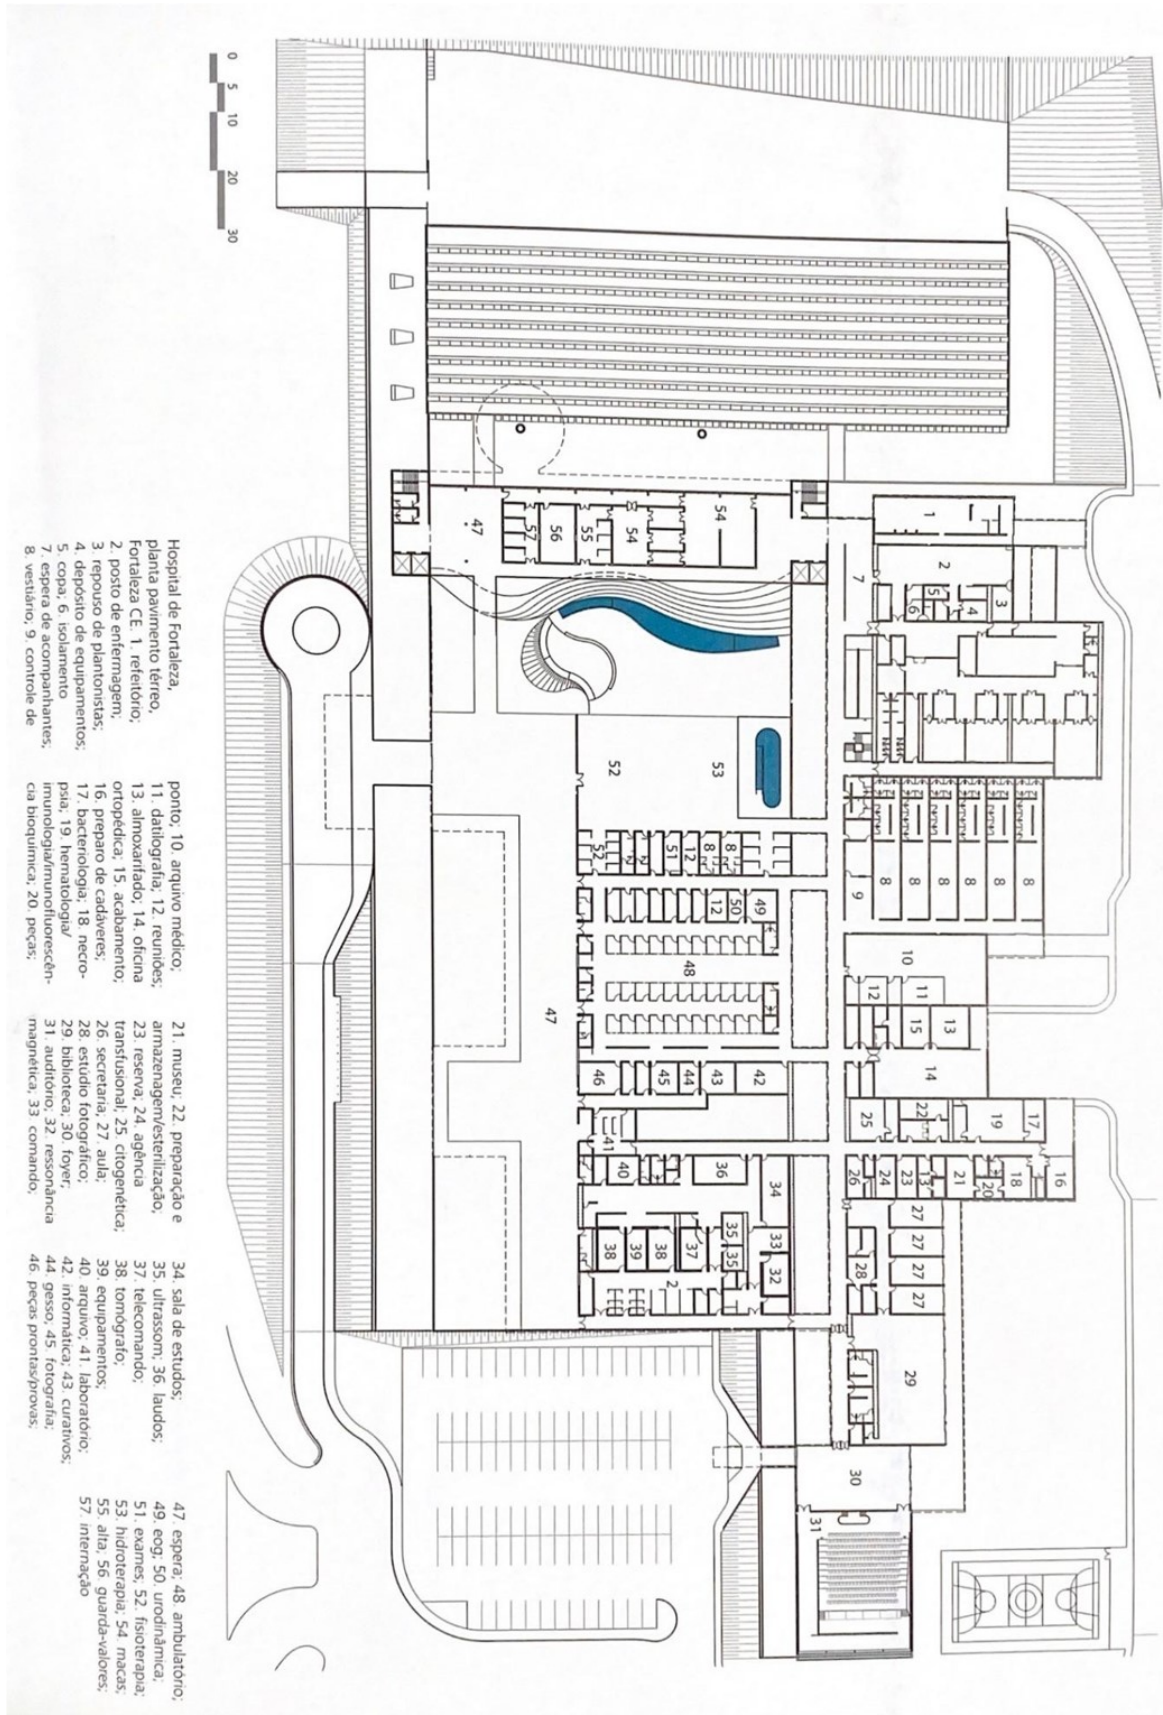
Planta pavimento Primeiro Subsolo - Hospital SARAH Fortaleza
